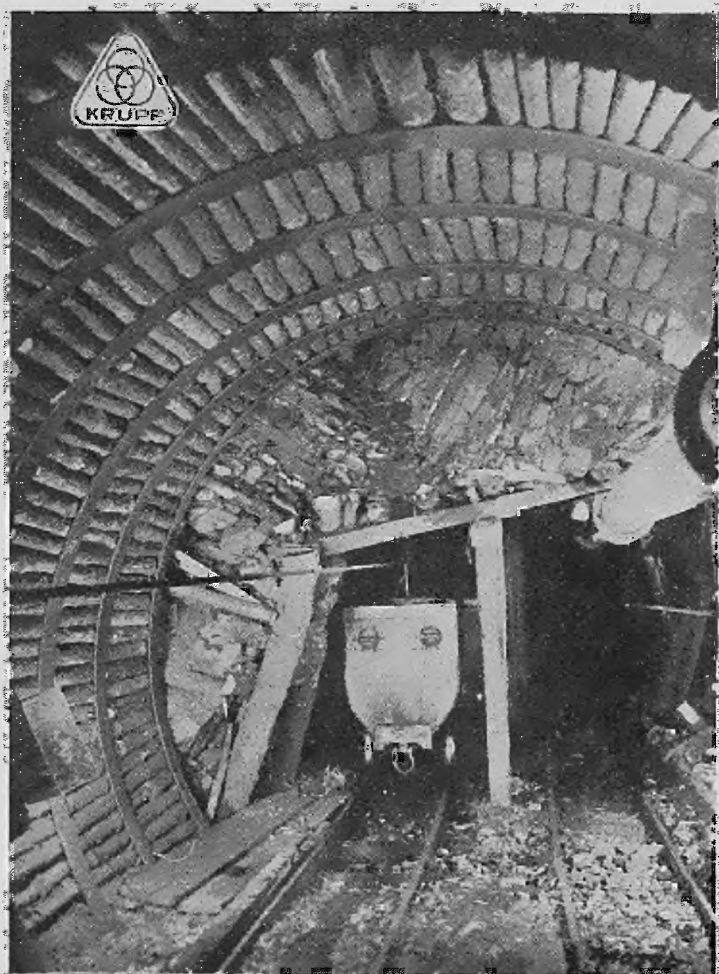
Umbau einer Grundstrecke in Eisenringen aus Breitflanschträgern
